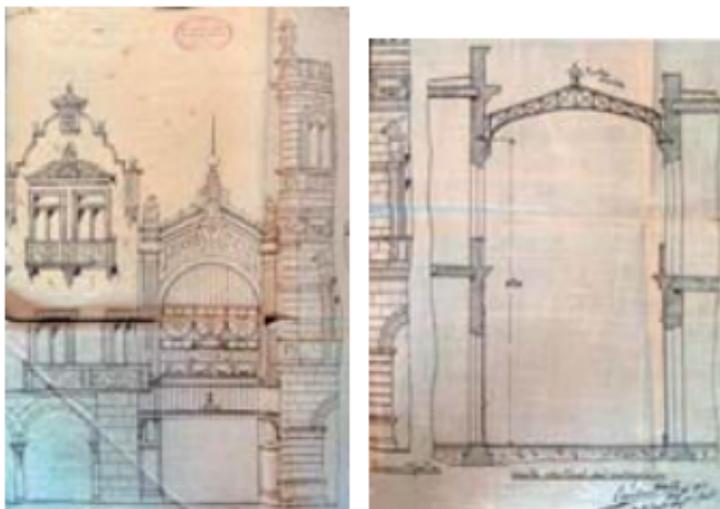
Planos originales del Pasaje del Ayuntamiento de Puebla, arq. Carlos Hall, 1903
